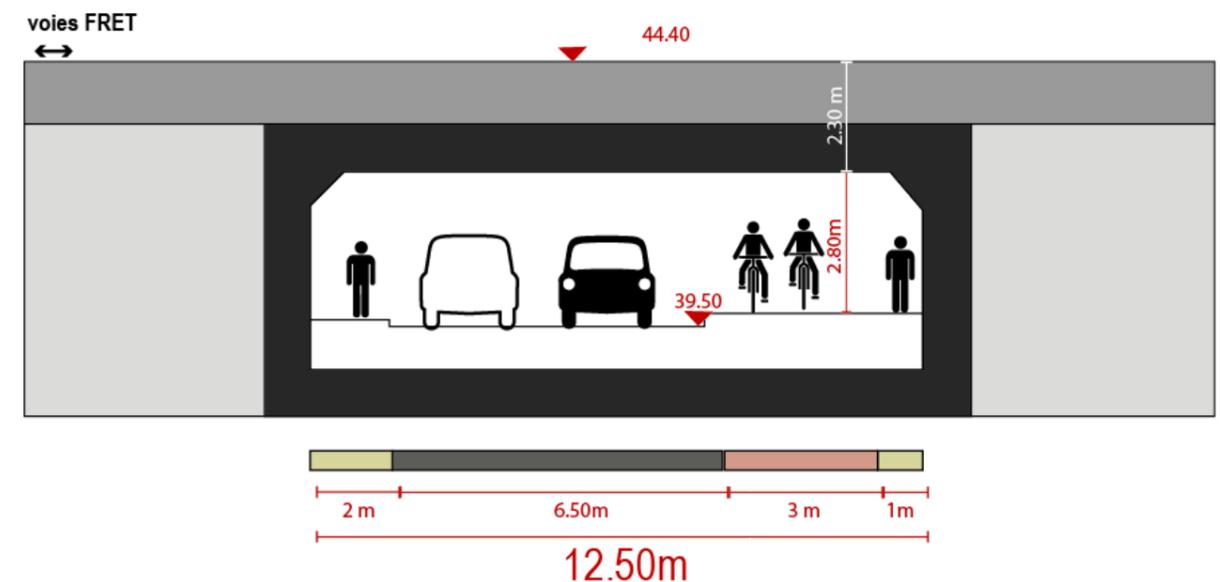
Coupe de principe de l'ouvrage cadre (source : Egis)
